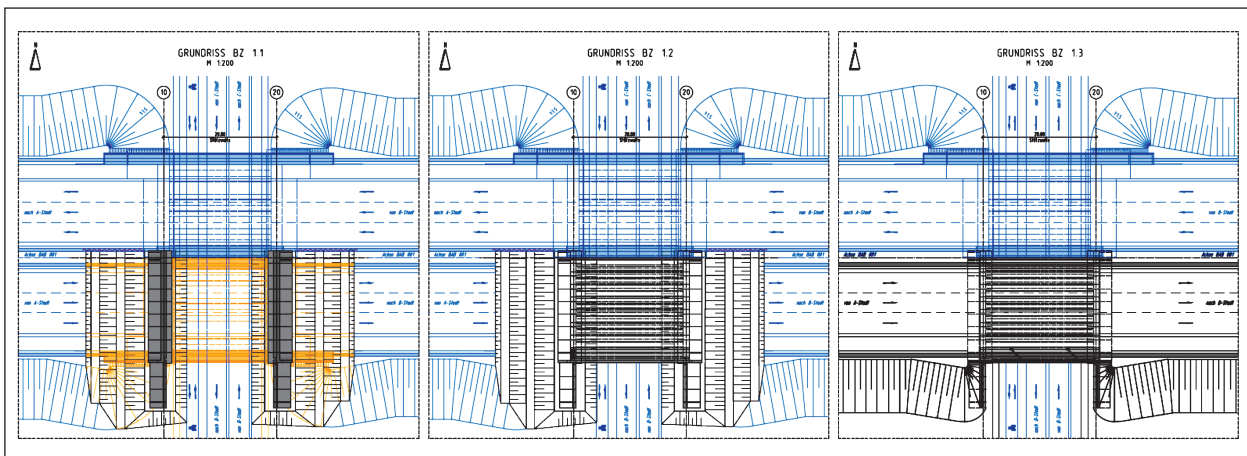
Aufbau des südlichen Teilbauwerkes
